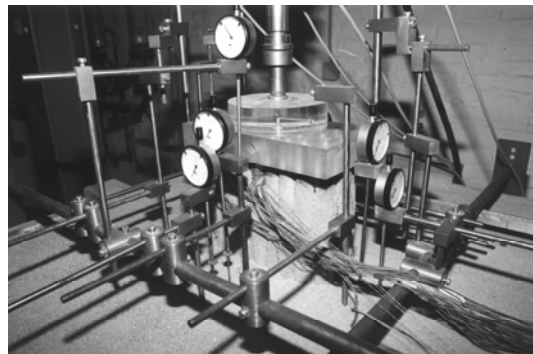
Оборудование для испытания коробчатого свайного фундамента
